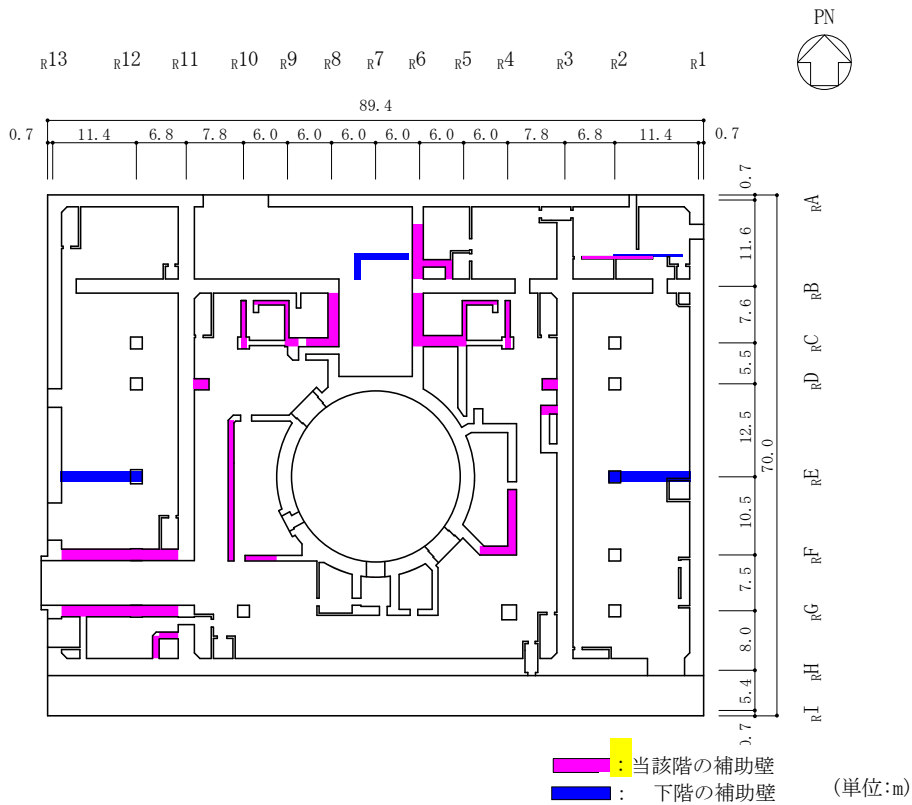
(2) 補助壁の配置図 (EL 15.3m)
